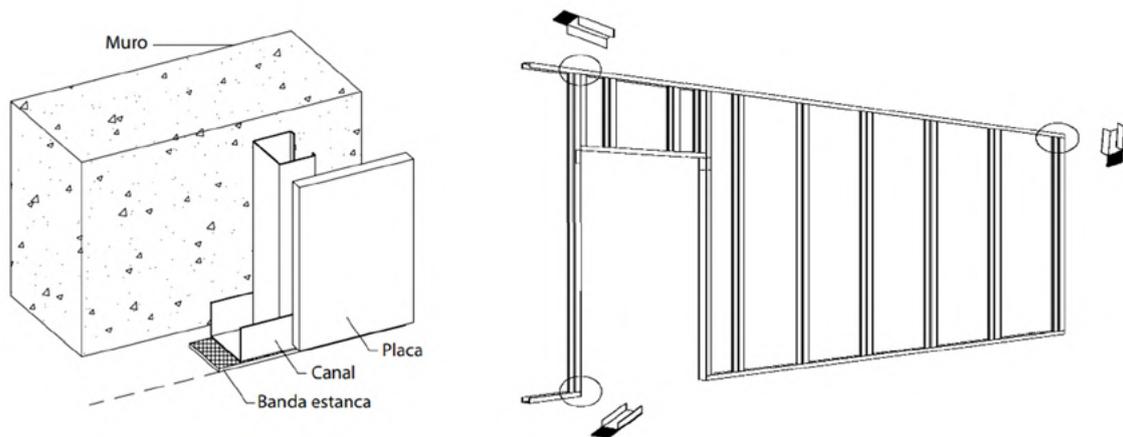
Componentes de un trasdosado de PYL autoportante con estructura metálica y detalle instalación de la banca estanca los canales perimetrales del trasdosado autoportante
